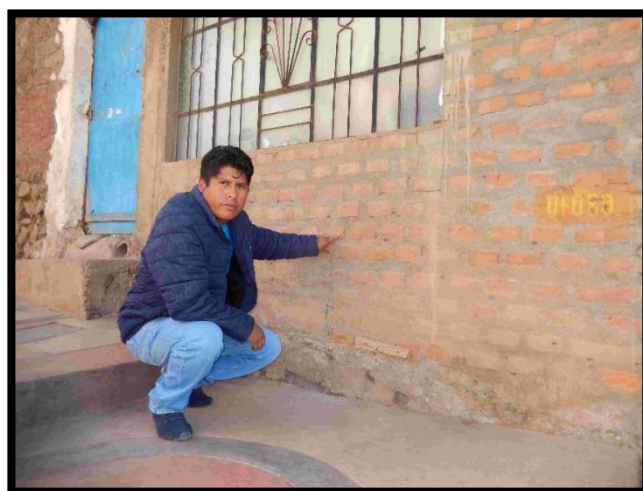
Presencia de fisura en el muro de una vivienda
